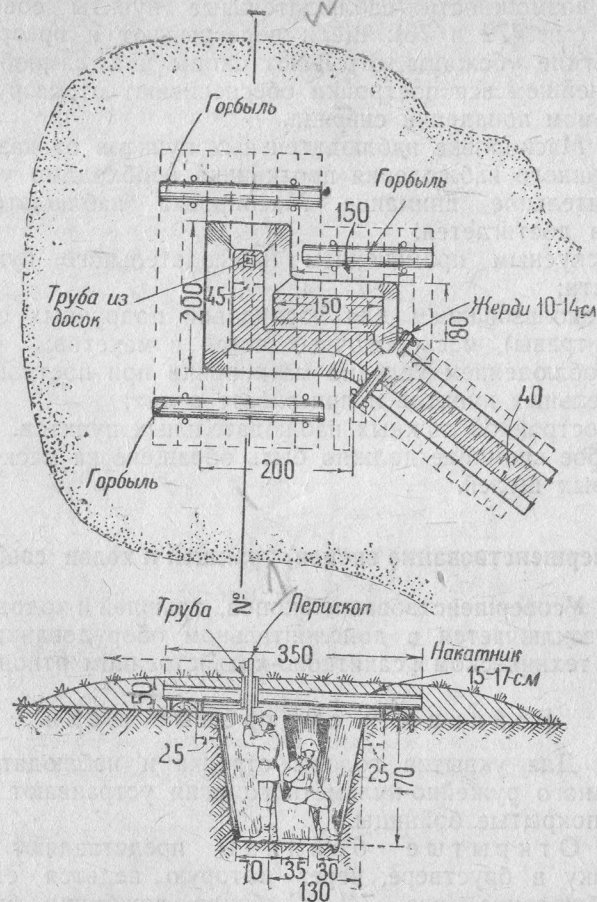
Наблюдательный пункт с лёгким перекрытием для наблюдения при помощи перископа или стереотрубы.
